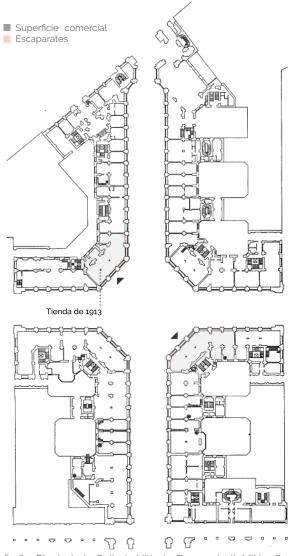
Planta baja Galleria Vittorio Emanuele II, Milán. Se señalan las tiendas Prada.
